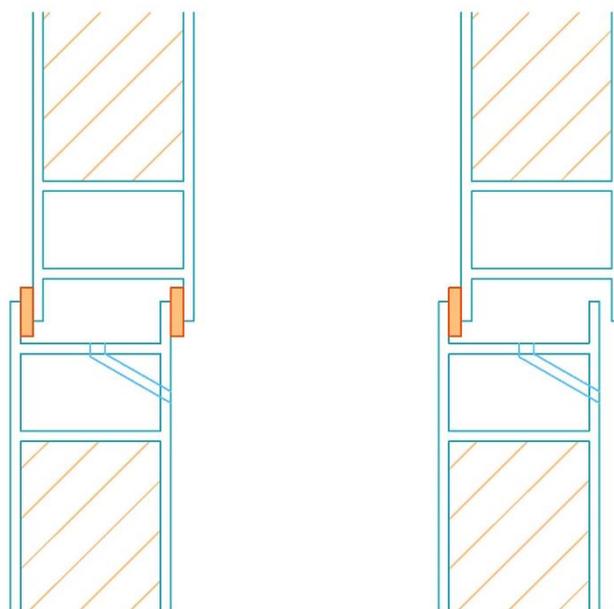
Junta impermeable cerrada y junta impermeable abierta (Rodríguez, 1996)
